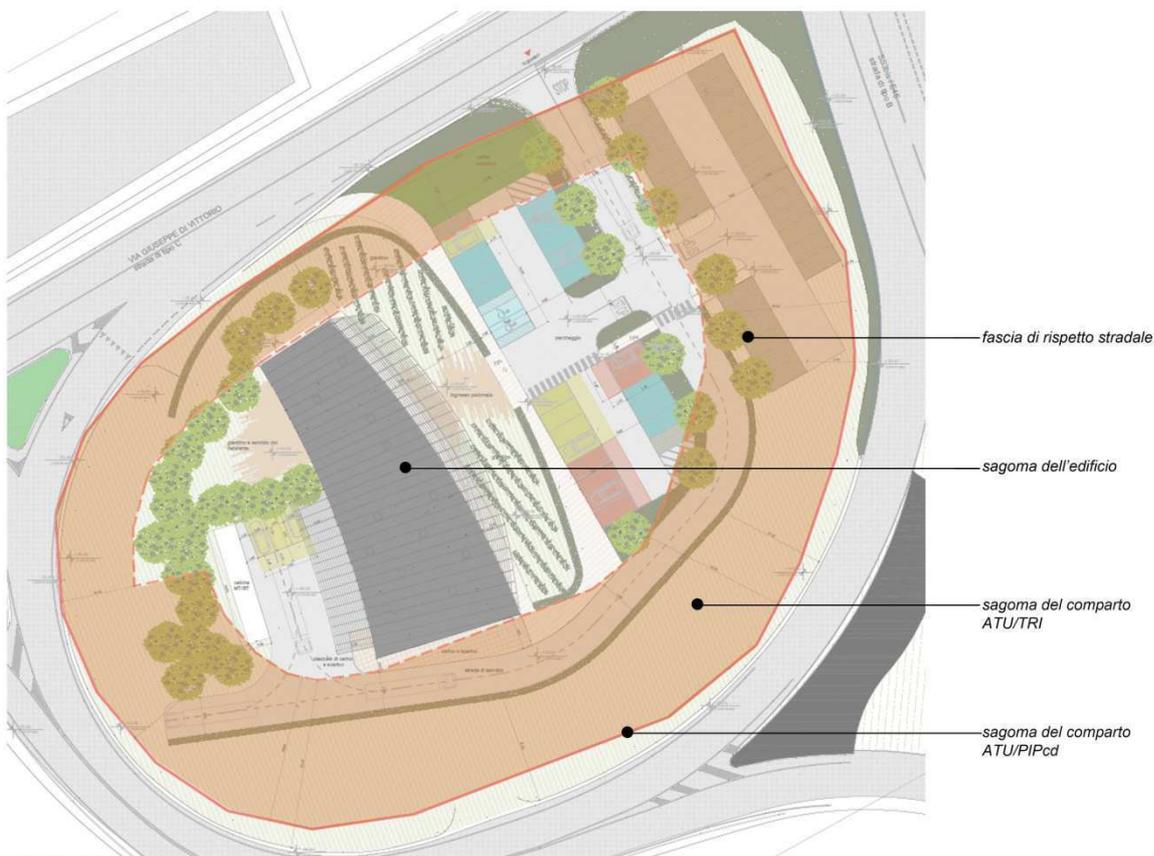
il progetto rispetta sia il vincolo del comparto ATU/TRI che il vincolo delle fasce di rispetto stradali.
